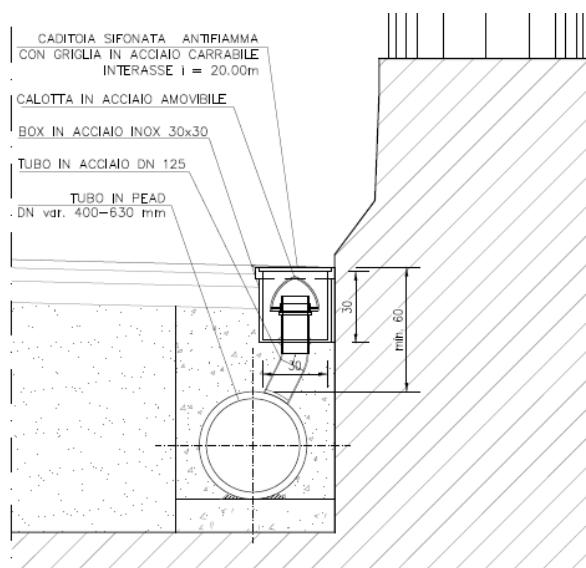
sezione tipo elemento di drenaggio in galleria.
